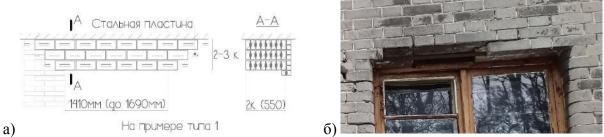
a) – конструкция перемычек малого пролета (до 1,7 м) – дома типов 1, 2, 3, 3a (схема), б) – армирование лицевой кладки полосовой сталью (фото)
